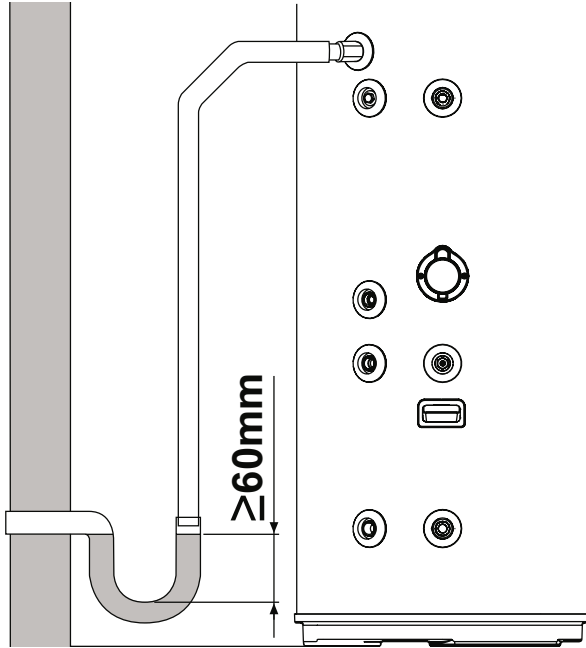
Esempi di collegamento di scarico della condensa attraverso un pozzetto di intercettazione
